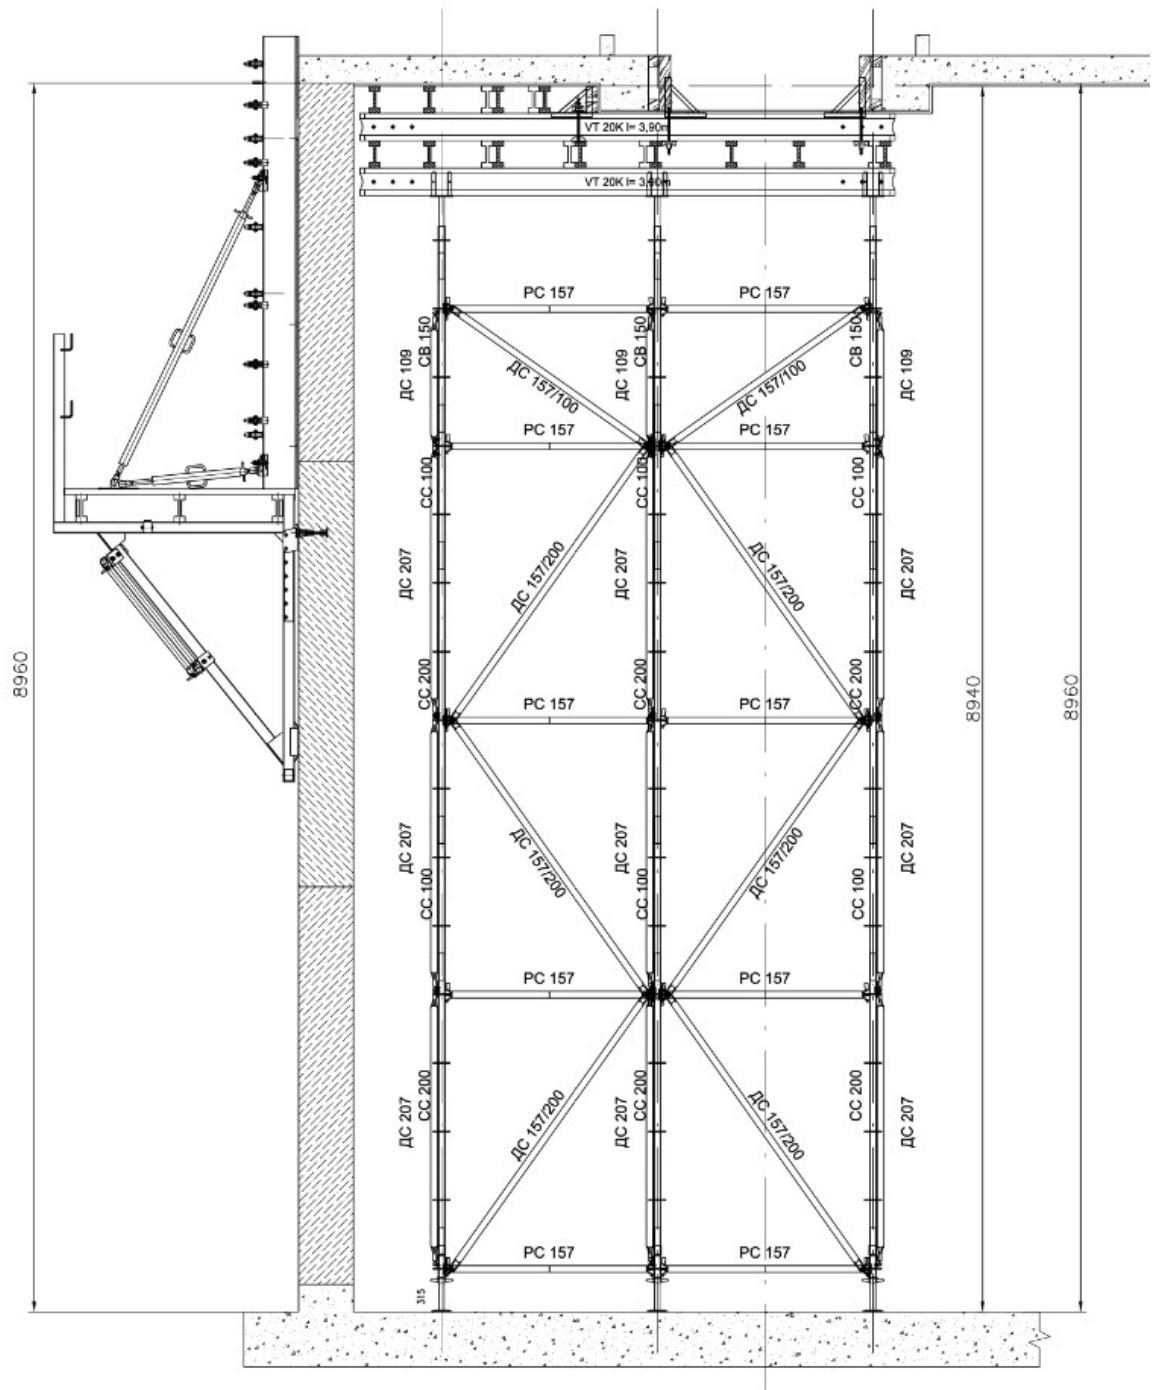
Бетонування горизонтального перекриття «друге світло»
